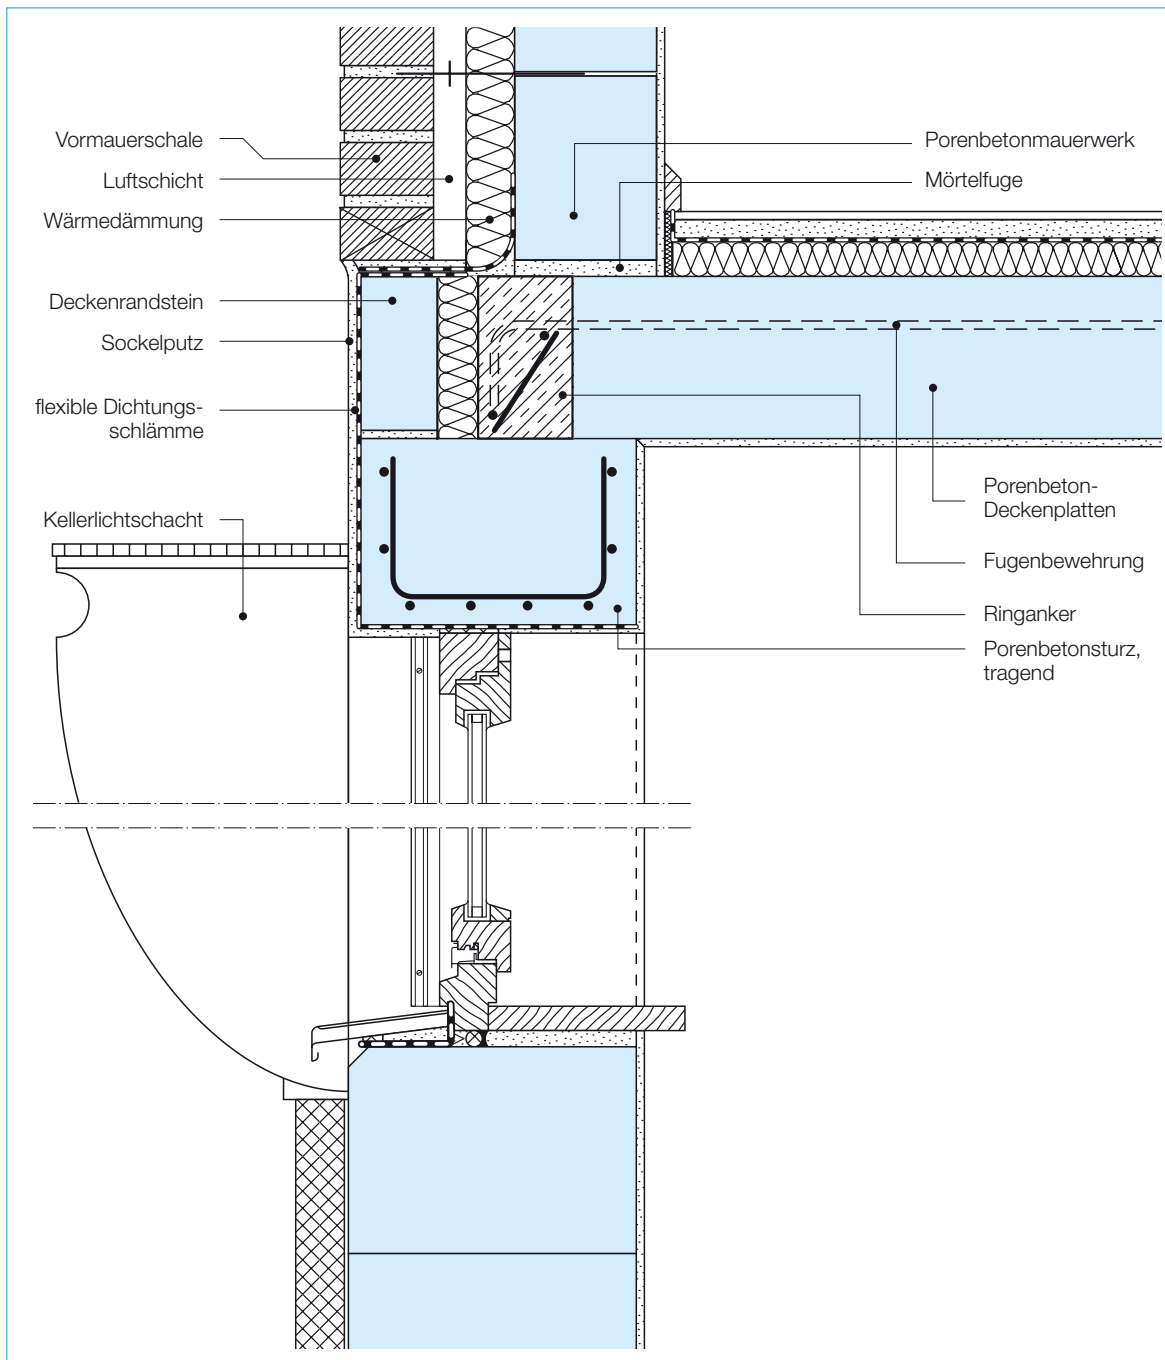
Keller-Außenwand aus Porenbetonmauerwerk mit Fenster, tragendem Porenbeton-Sturz und Geschosseckenanschluss (Porenbeton-Deckenplatten)
